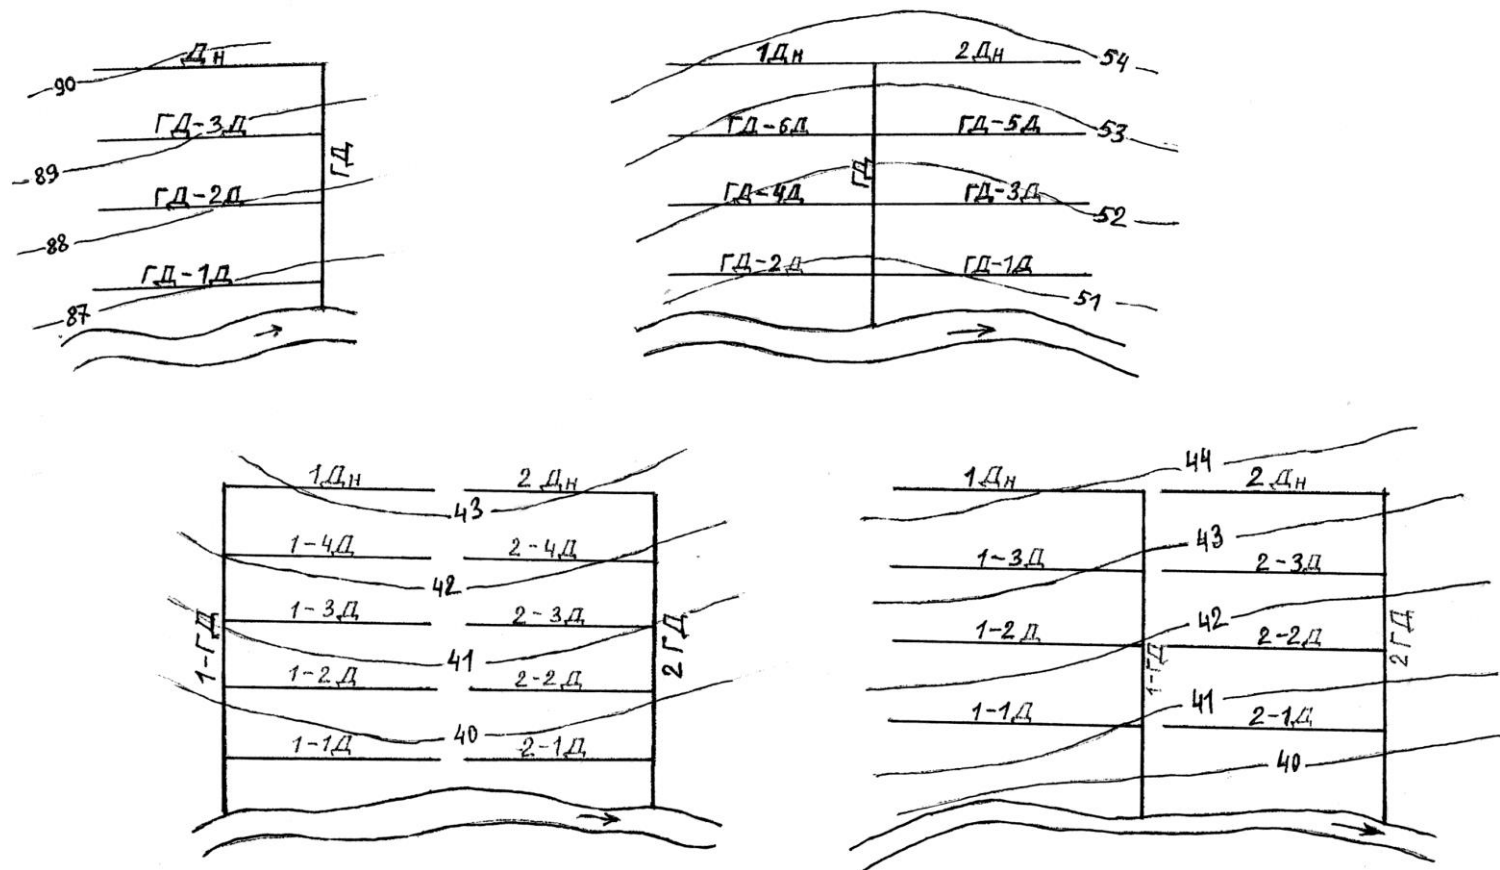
Схемы расположения в плане открытой осушительной сети
